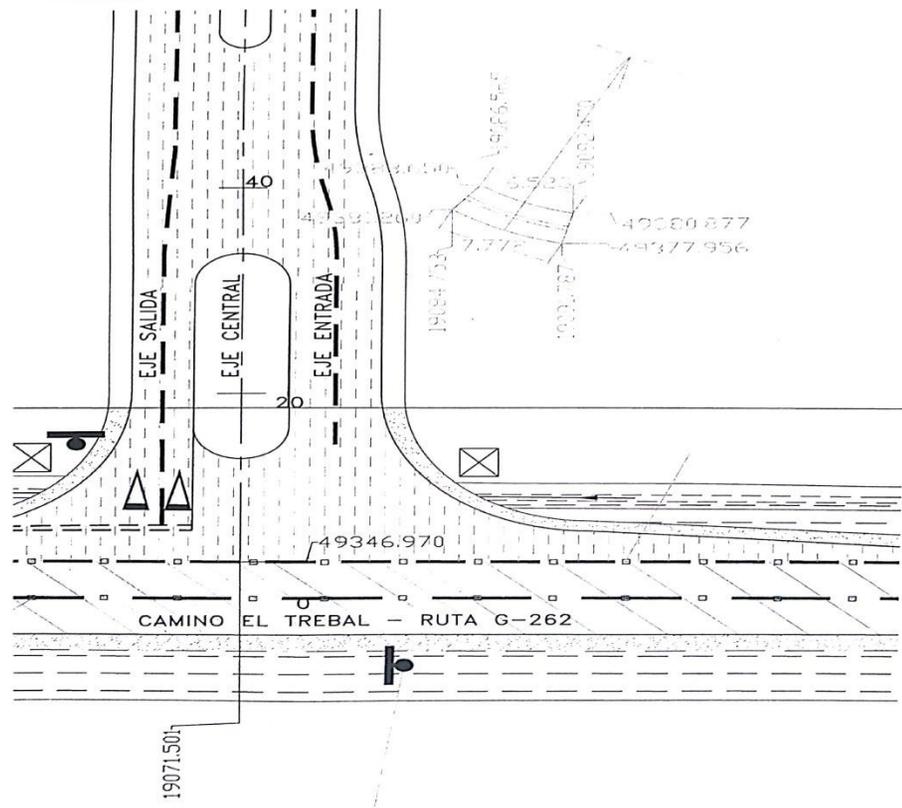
Plano de ubicación de la plata de de tratamiento(fuente: escáner de plano)
